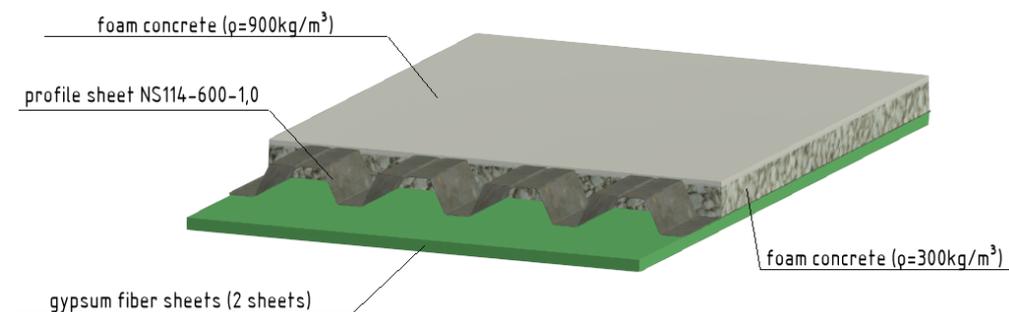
Конструкция перекрытия с несущим профилированным листом
